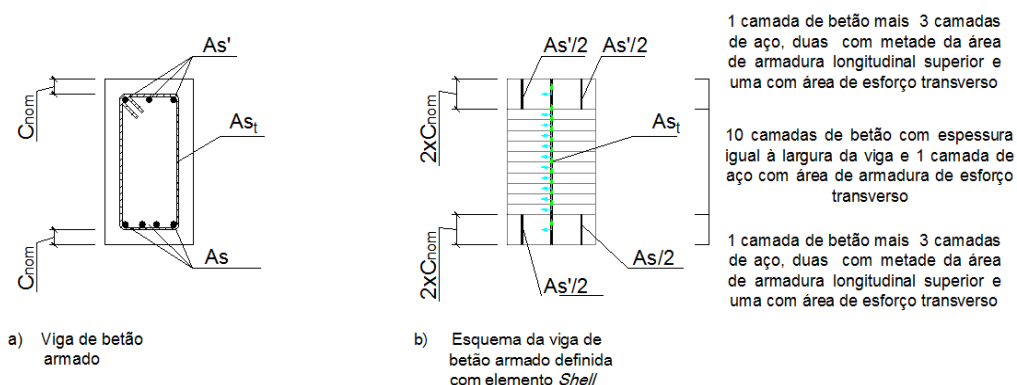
Comparação entre uma a) secção real de viga de betão armado e b) secção definida por elementos *Shell* não lineares
